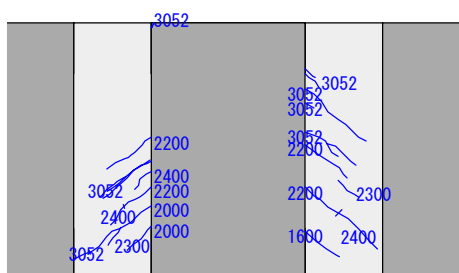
ひび割れ図（せん断キー無し：No.3）
